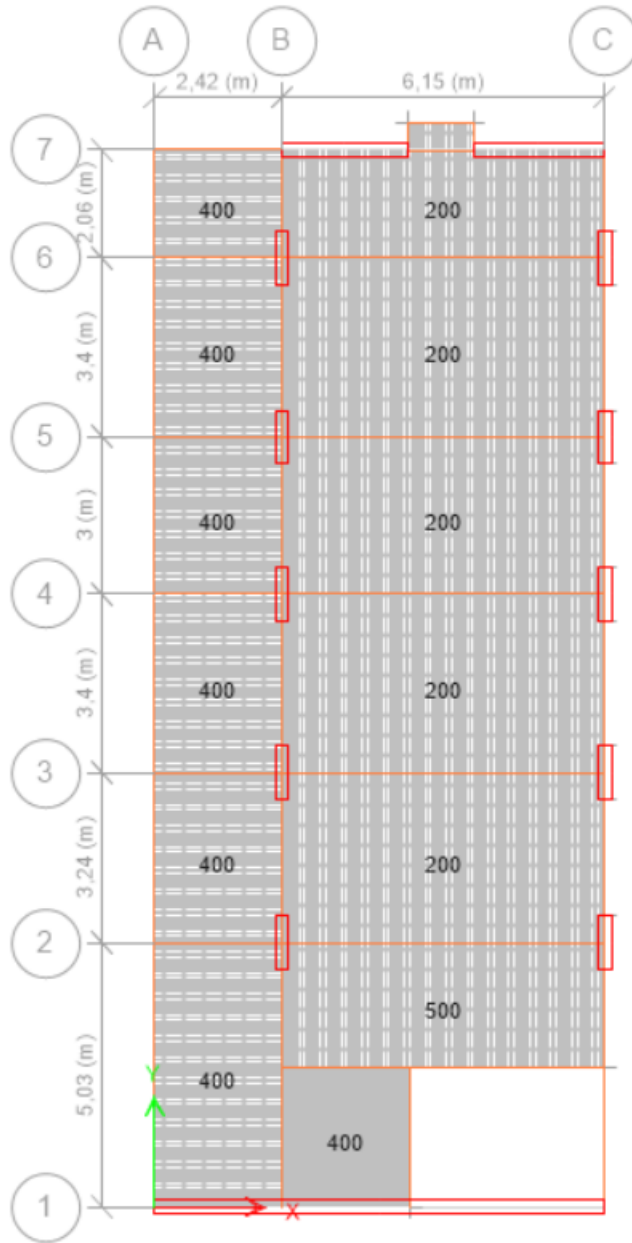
Cargas aplicadas por paño de losa en bloque de dormitorios y circulación vertical y horizontal.
